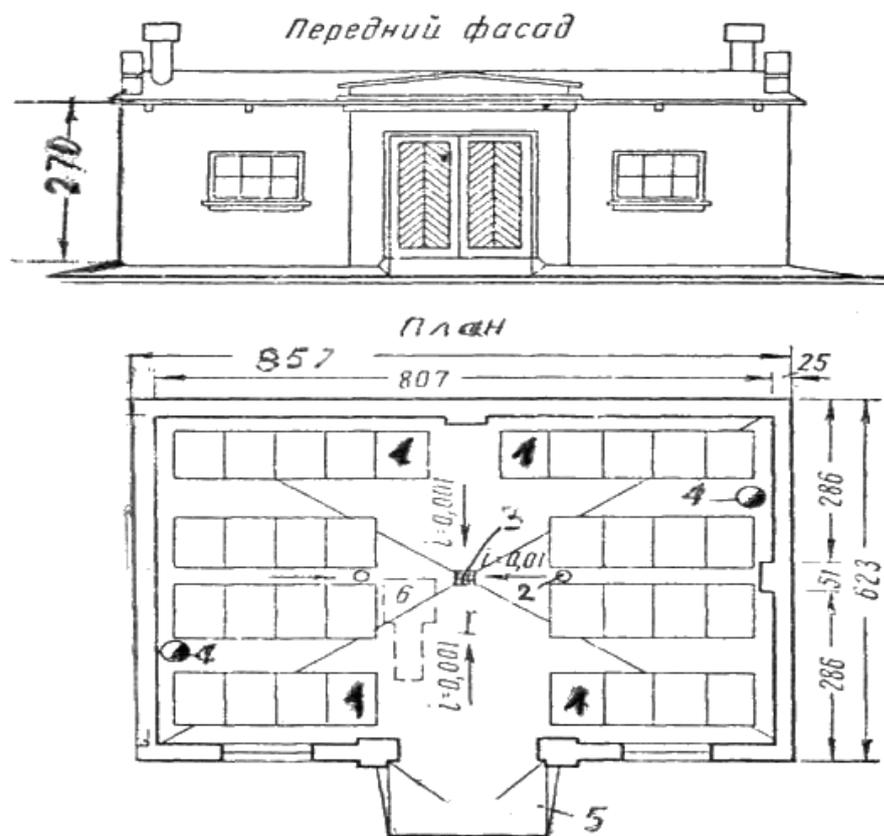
Схема хранения для нефтепродуктов в таре: 1- штабели с бочками; 2-огнетушитель; 3-трап (канализационная решетка); 4-вытяжной канал; 6-передвижная эстокада для укладки второго яруса бочек
